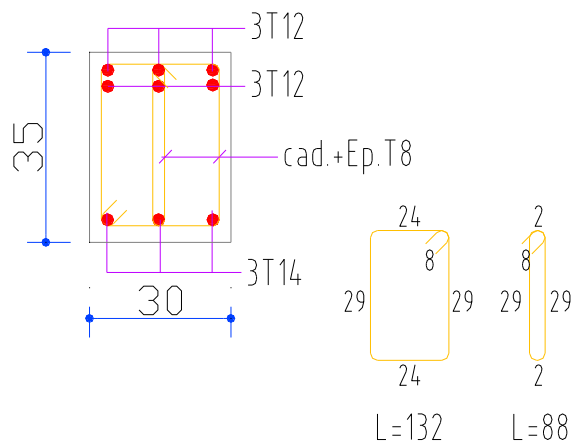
Ferrailage des poutres secondaires au niveau d'appui de niveaux RDC et terrasse.
